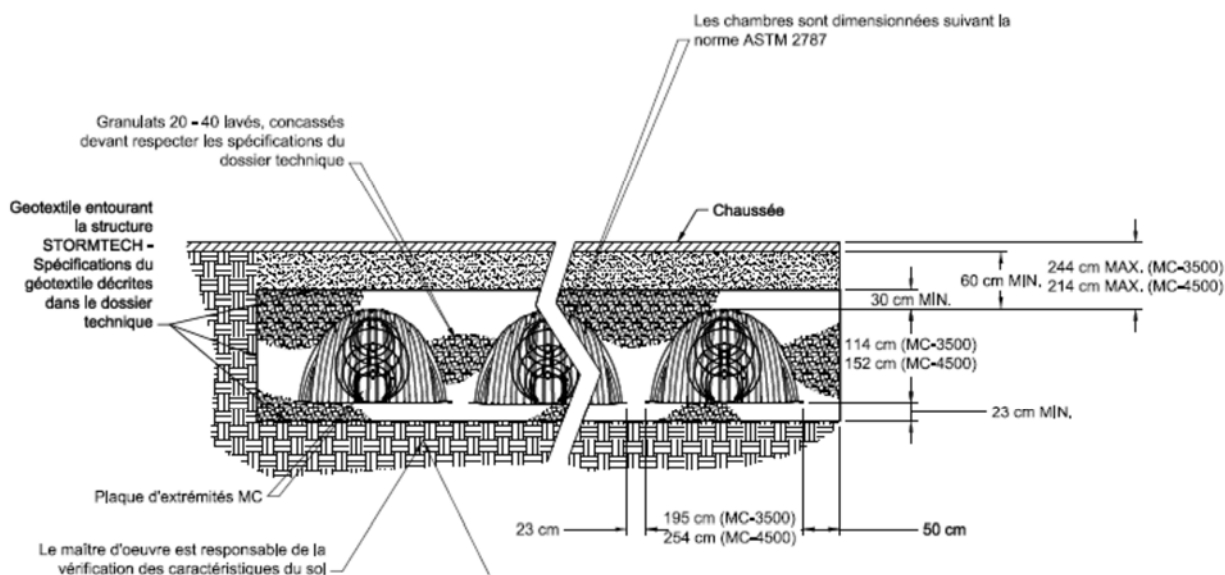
Plan en coupe de l'installation avec ou sans charge roulante (Chambres STORMTECH MC3500 and STORMTECH MC4500)
